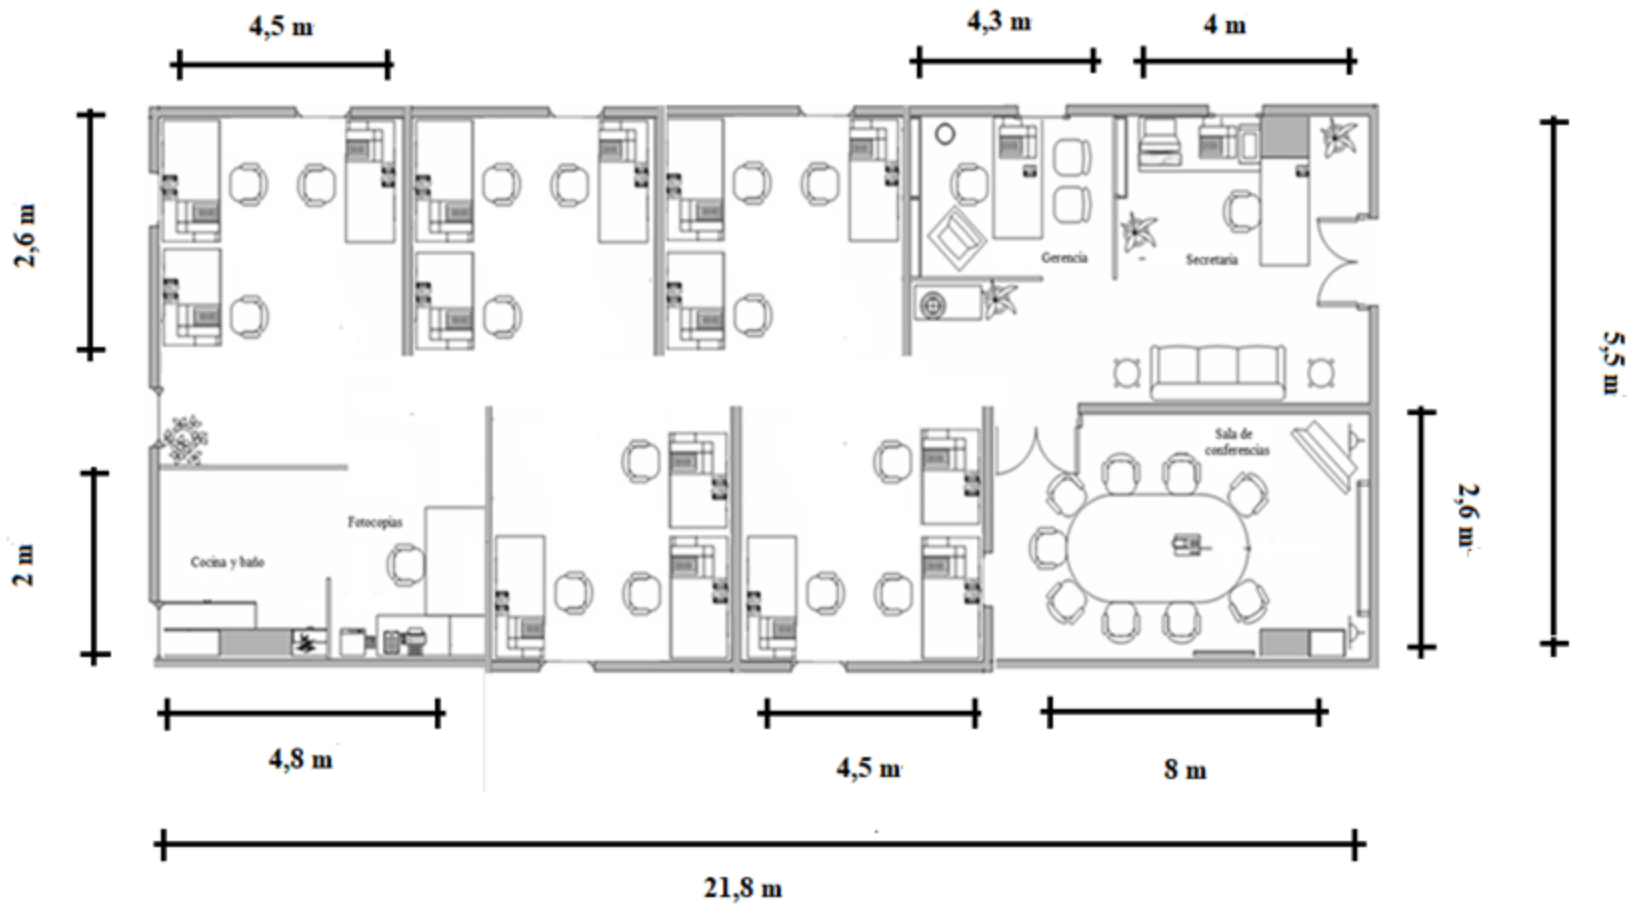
Plano de la distribución interna. Fuente <http://www.interio.es/distribucion-division.html>
